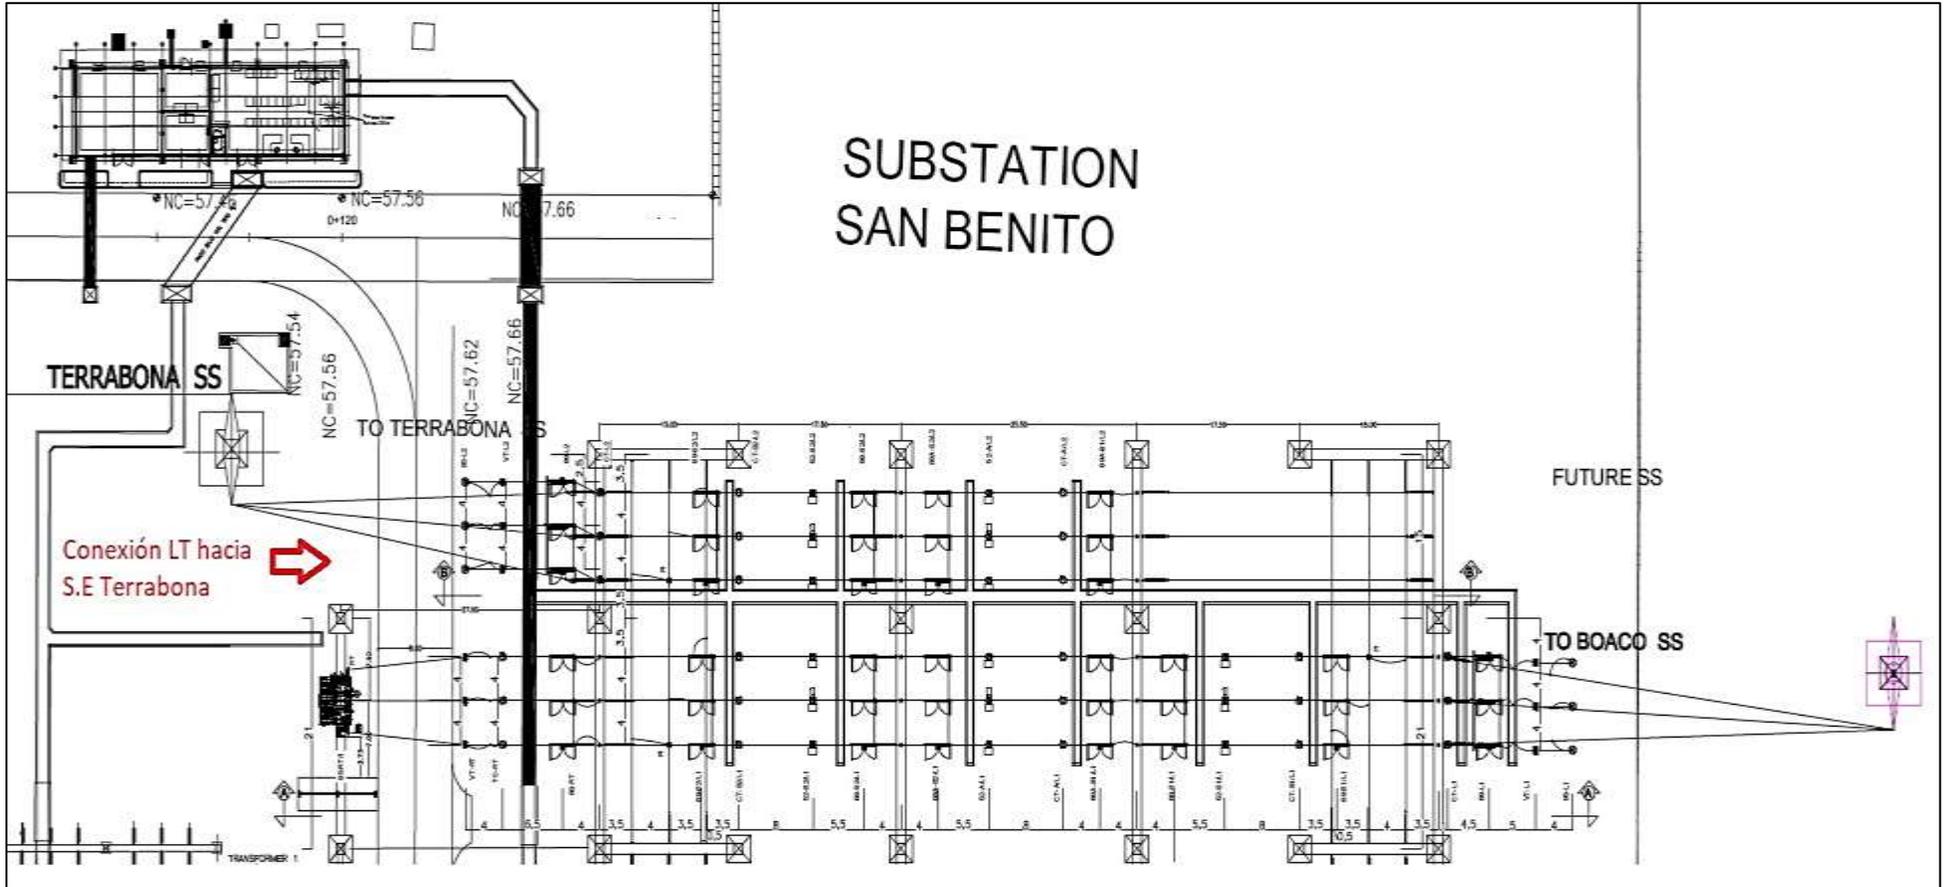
Vista en Planta del proyecto “Ampliación Subestación Terrabona”
